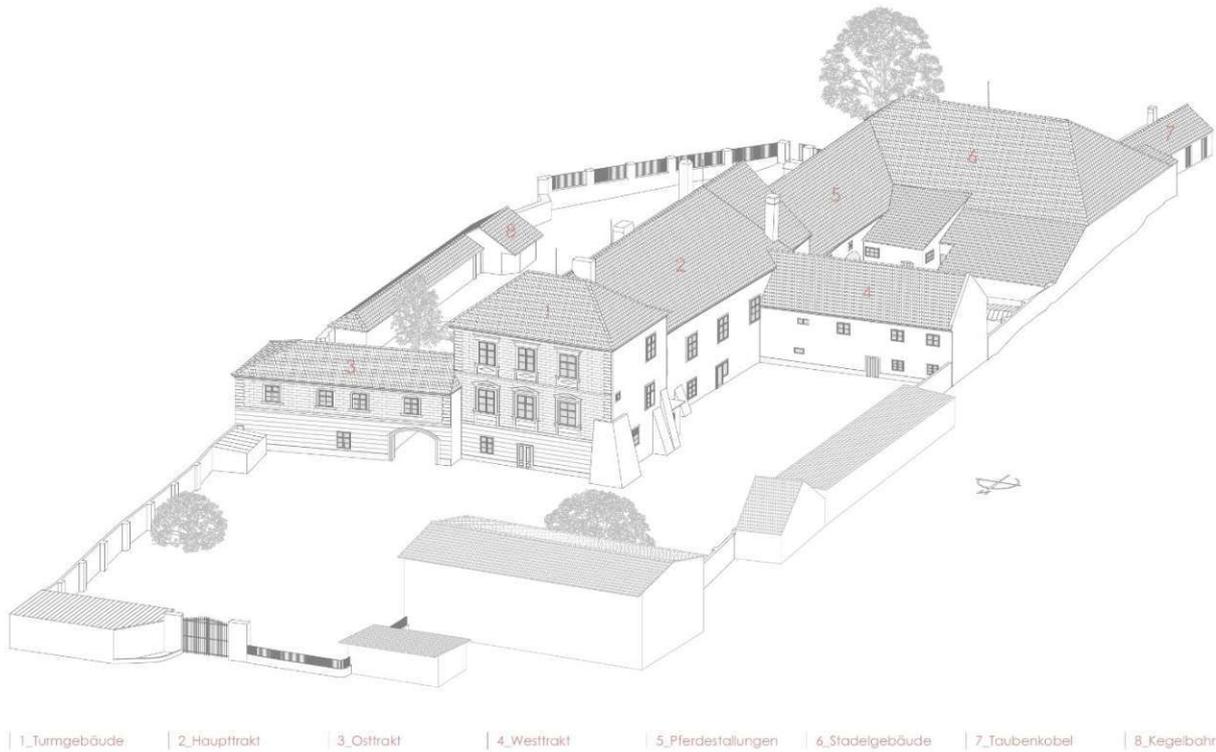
Axonometrie Bestandsgebäude Nordwest
